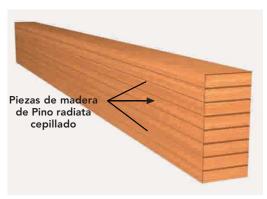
60 : Viga laminada compuesta por 8 piezas (en la altura) de madera seleccionada cepillada.
